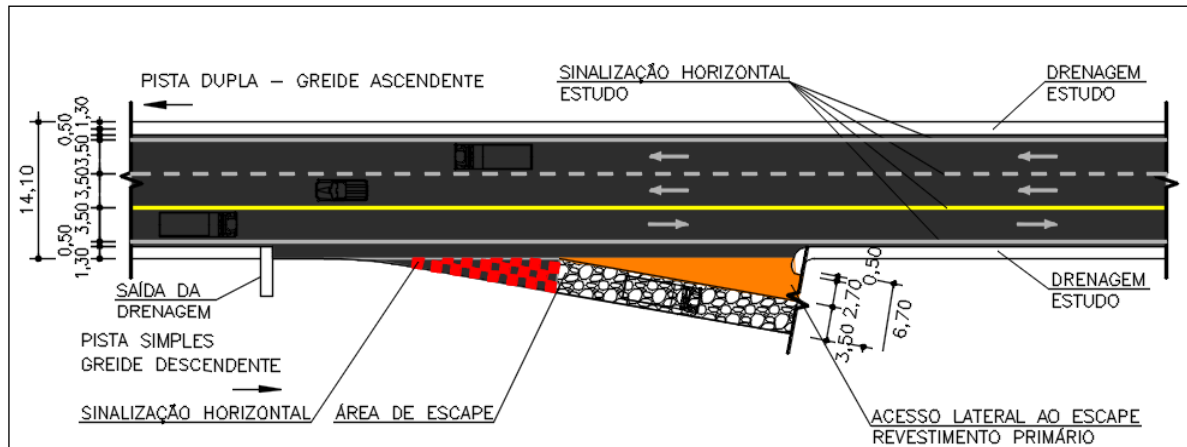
Rampa de Escape – Plataforma Final - Área de Escape em Tangente.
